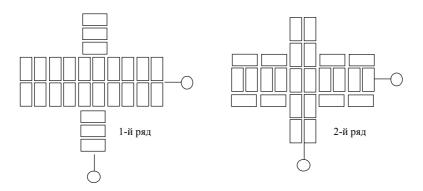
Кладка пересечений стен толщиной в 2,0 и 1 кирпич
